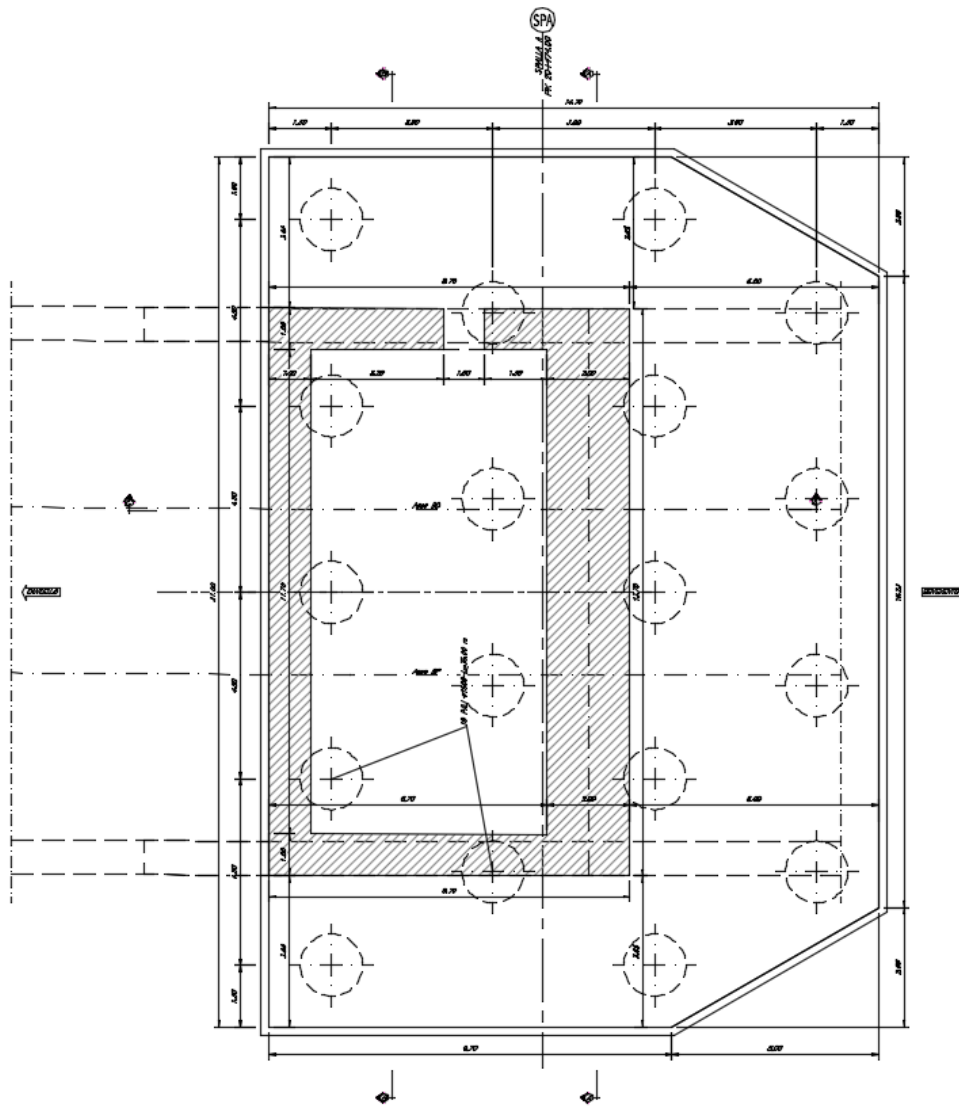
Pianta allo spiccato fondazione della spalla A
